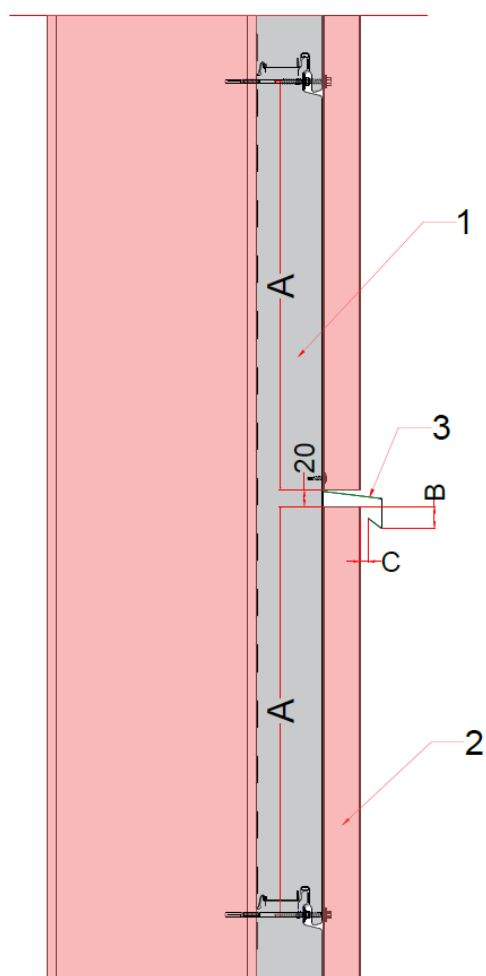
ter : Exemple de baie avec parement extérieur de la typologie 3 à « claire-voie » sur double réseau avec panneaux sandwich isolants posés verticalement – Coupe longitudinale
